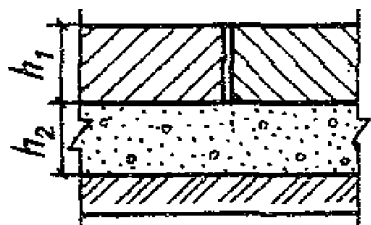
Конструкція жорсткого дорожнього одягу зі збірних залізобетонних плит у I-V дорожньо-кліматичних зонах: h_1 - збірне залізобетонне плити; h_2 - гравійно-піщана суміш (пісок).
